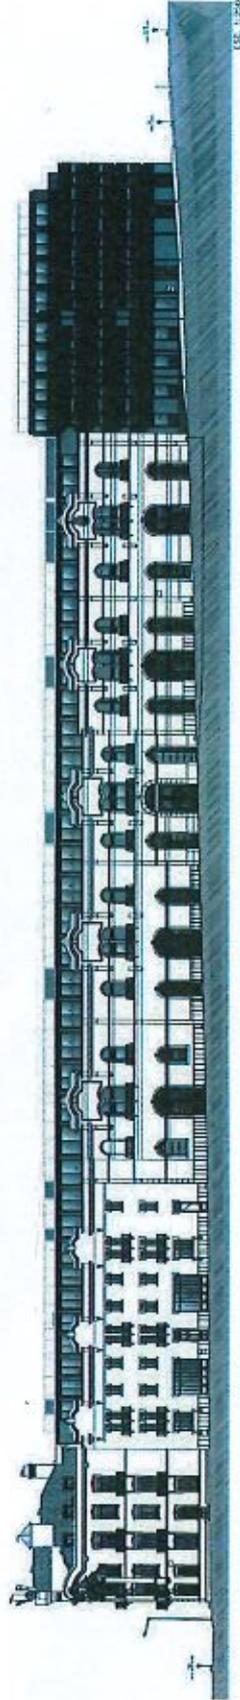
Excerto, Desenho da Proposta/Projeto de Licenciamento, fevereiro de 2021. Cortes e Alçados, Alçado nascente / Rua Fernando Palha 2.01.
